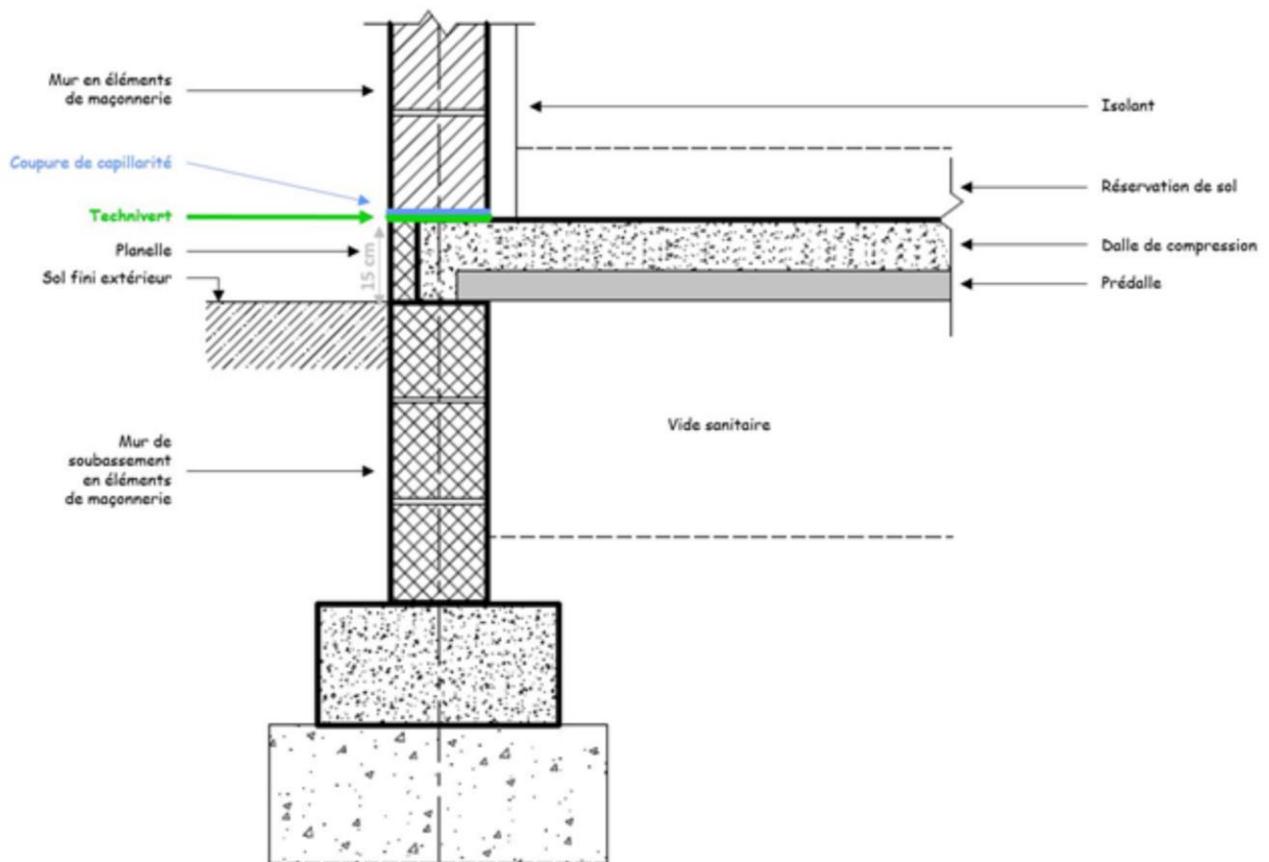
Plancher à prédalles industrialisées en béton - Elévations maçonneries
